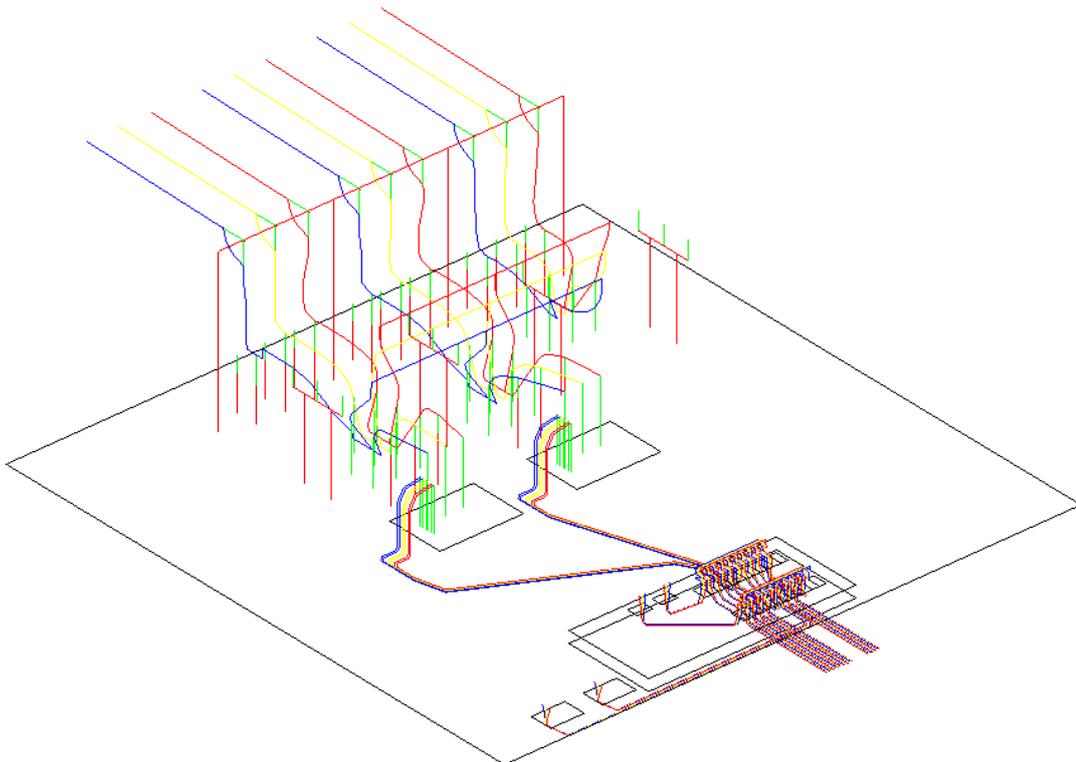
Vista 3D de los conductores de la subestación tipo Híbrida 132/MT simple barra 3L+2TR.
